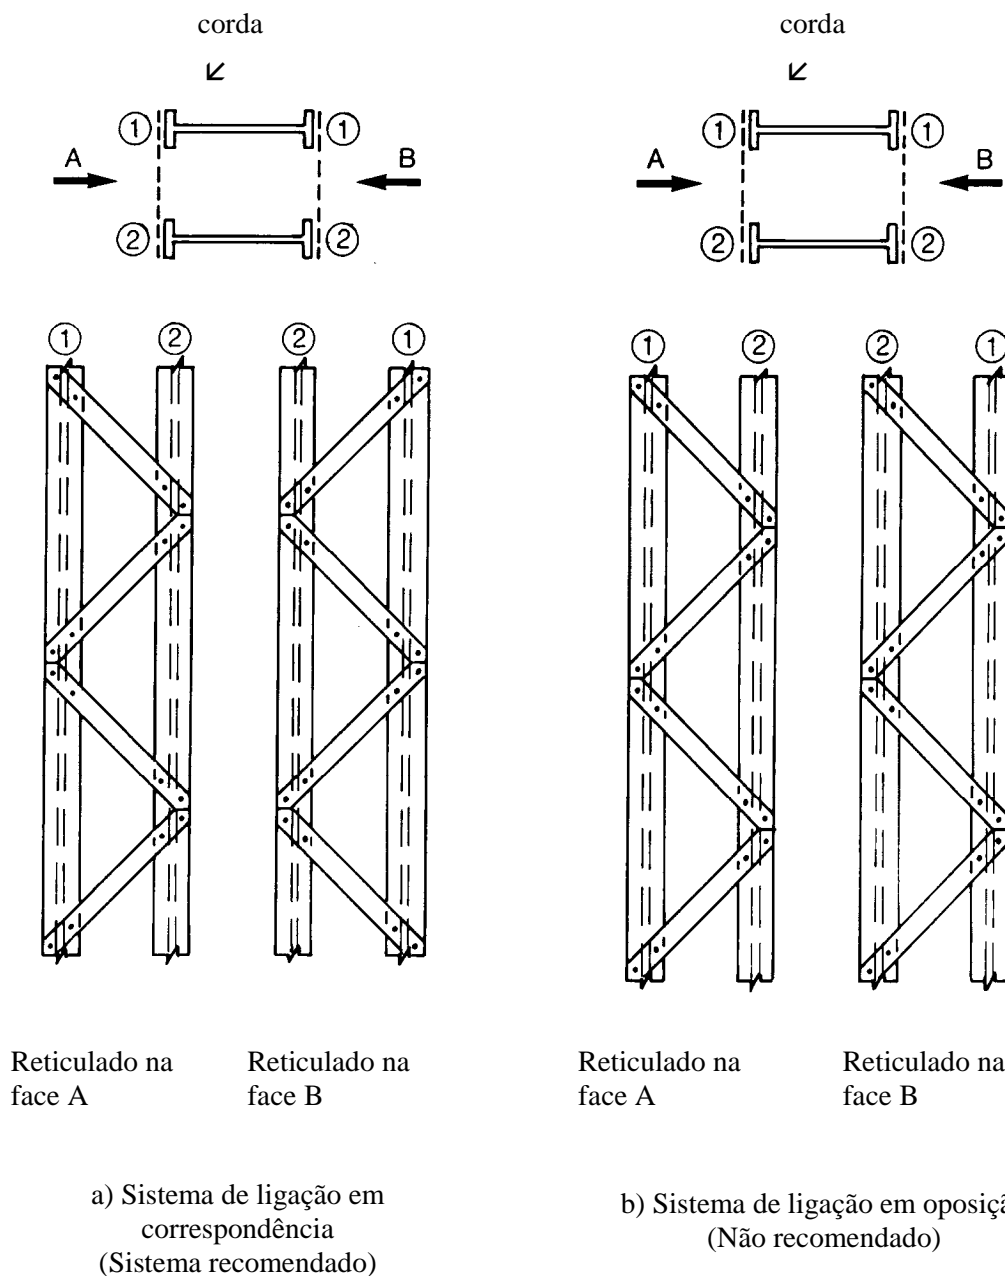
Sistemas de diagonais simples isoladas localizados em faces opostas de um elemento composto com dois planos reticulados paralelos
